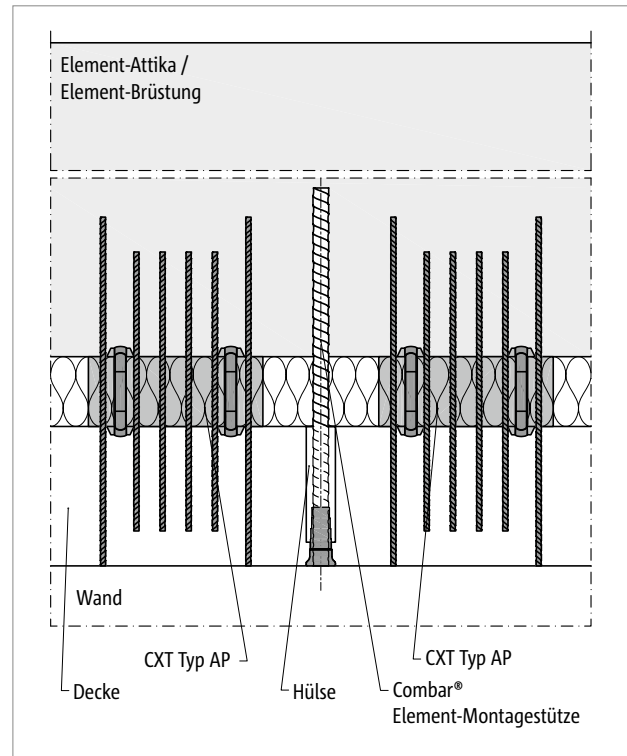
Schöck Combar® Element-Montagestütze: Einbau einer Elementattika; Ansicht
